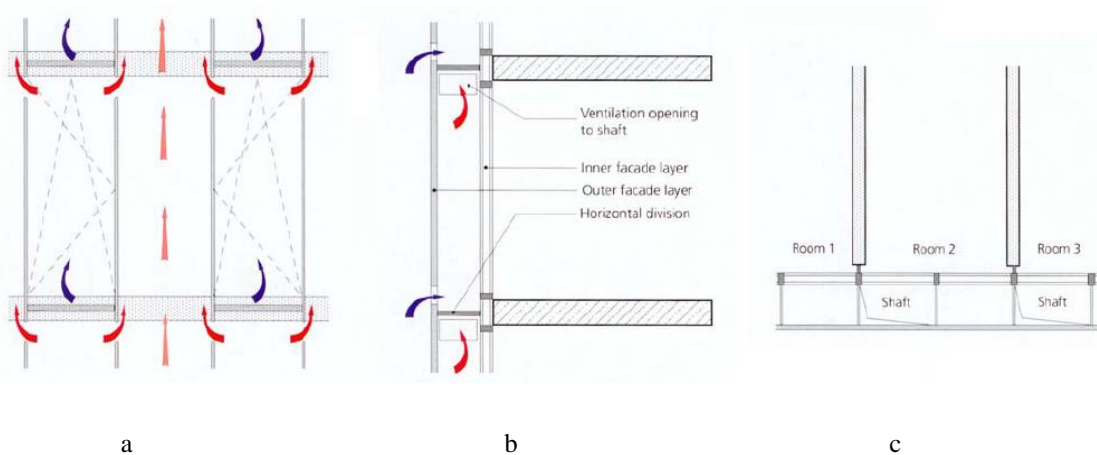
Coluna de Extração: Vista frontal - a); Secção transversal – b); Vista em planta – c) (Oesterle et al, 2001).
